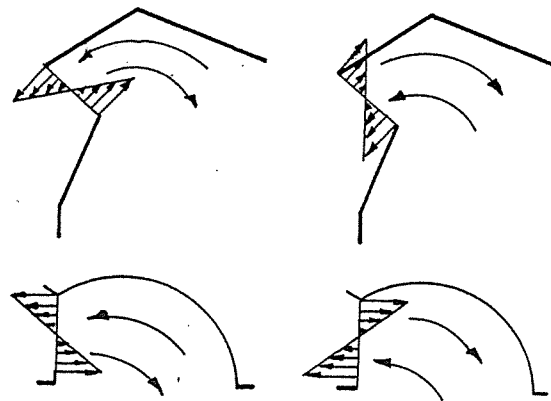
Solda Pencere , Sağda Şaft Havalandırması
